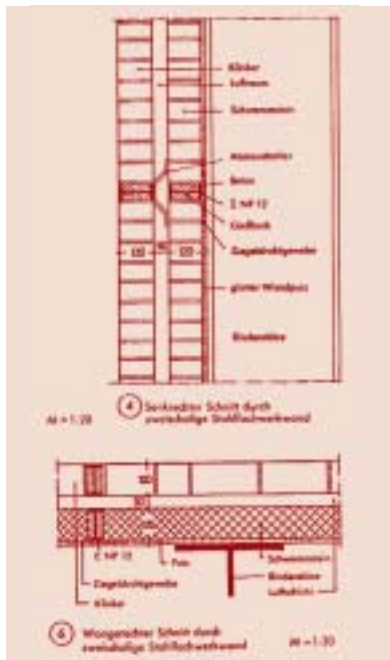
Vertikal- und Horizontalschnitt durch zweischalige Stahlfachwerk-wand, Schupp [Quelle: ebd.]
